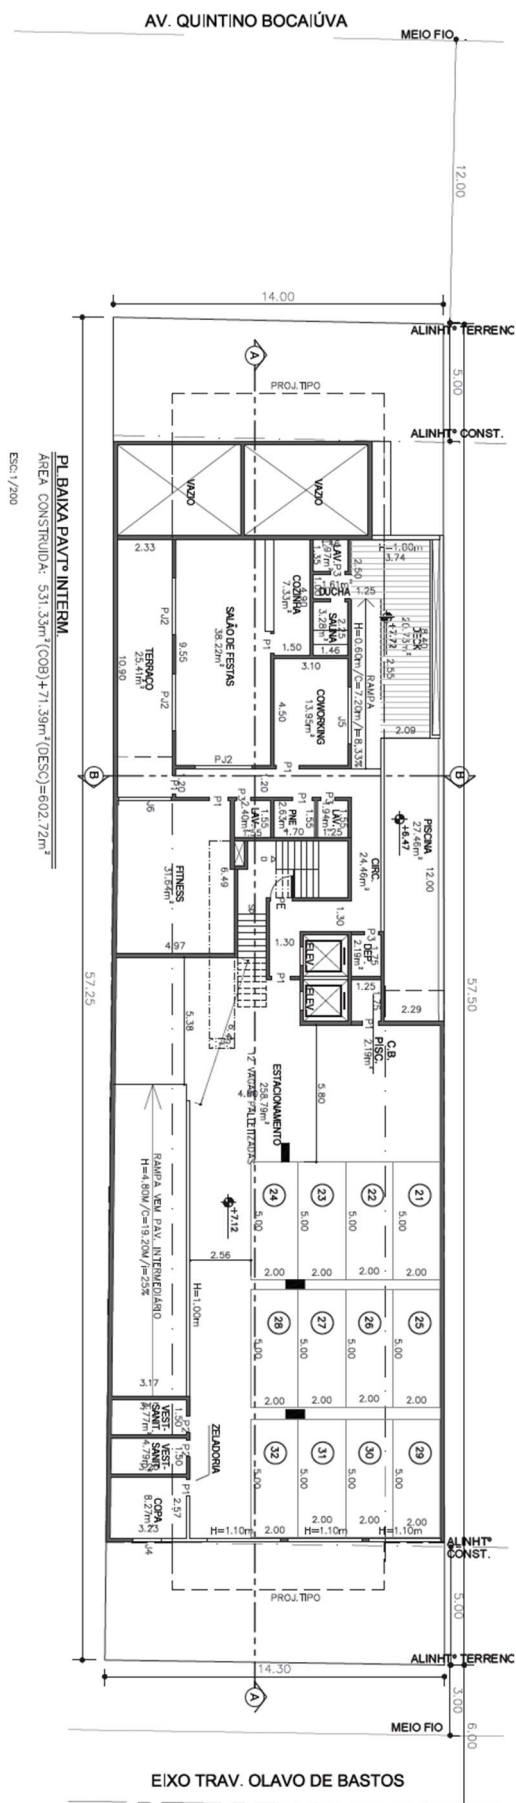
Pavimento intermediário - Fonte: Projeto Legal
